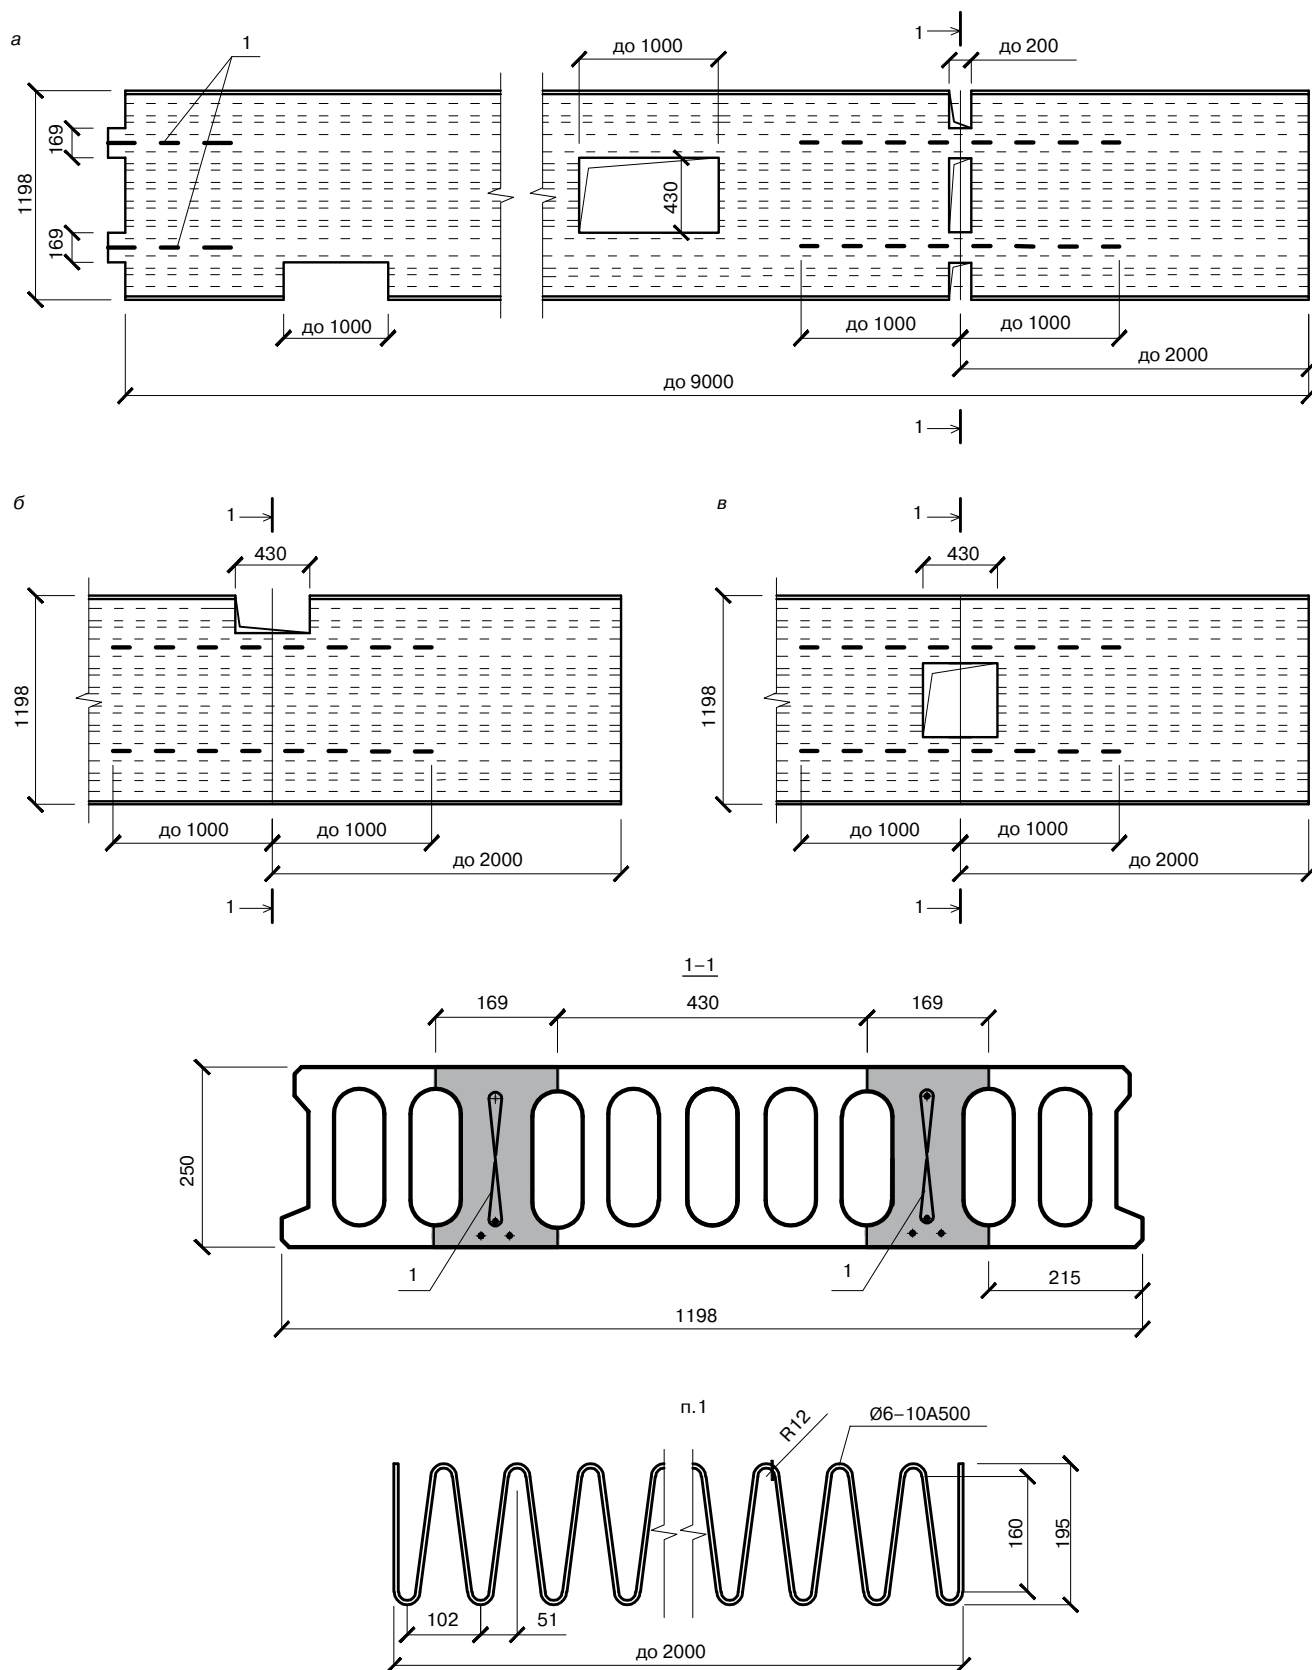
Плита пустотная с многопустотными усилителями. Варианты: а – для панельных зданий; б–в – для каркасных зданий. Затененная часть плиты на сечении 1–1 обеспечивает несущую способность на полезную нагрузку 8 кПа; консольная часть плиты (до 2 м) выдерживает нагрузку от навесных стен и ограждений до 11 кН/п.м
